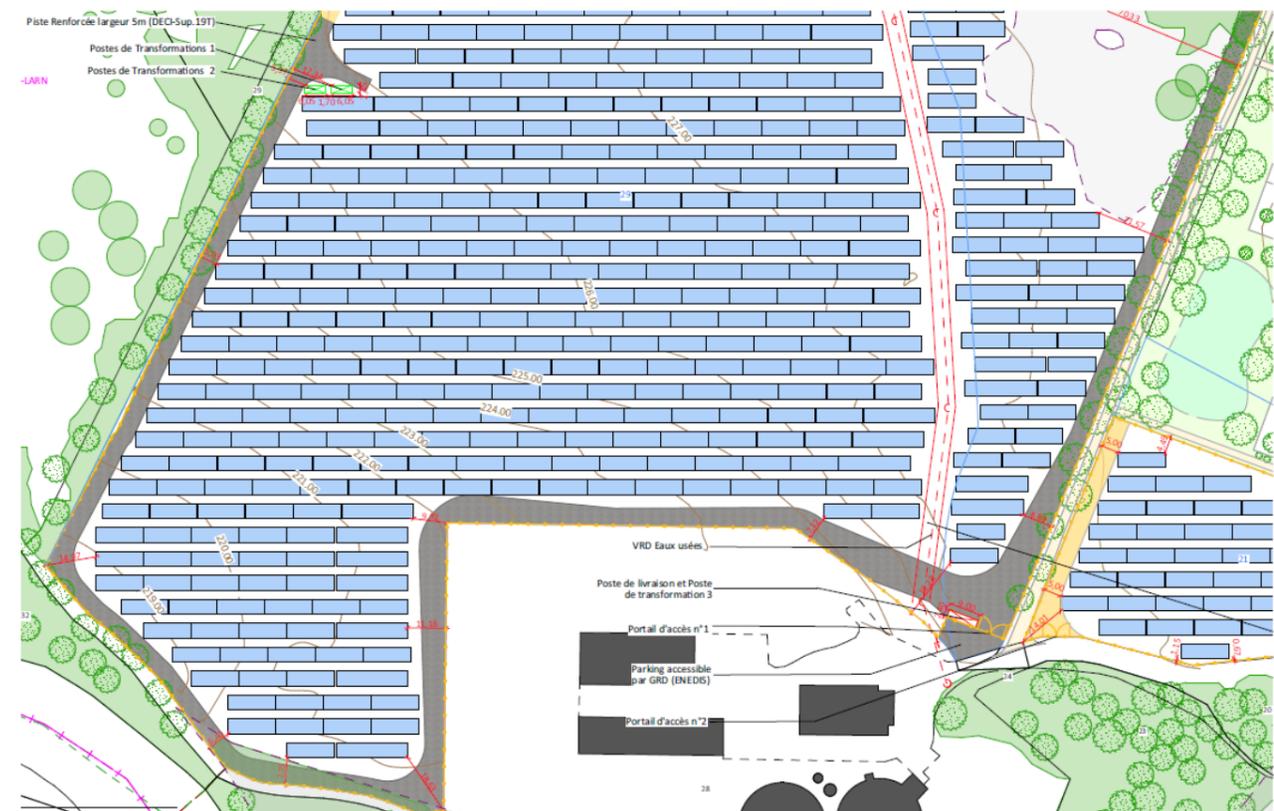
Plan de masse de la centrale photovoltaïque (Source : l'm In Architecture)
